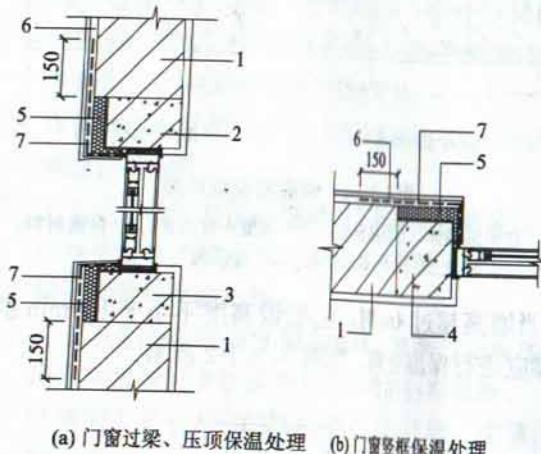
门窗过梁、压顶、钢筋混凝土框保温处理
